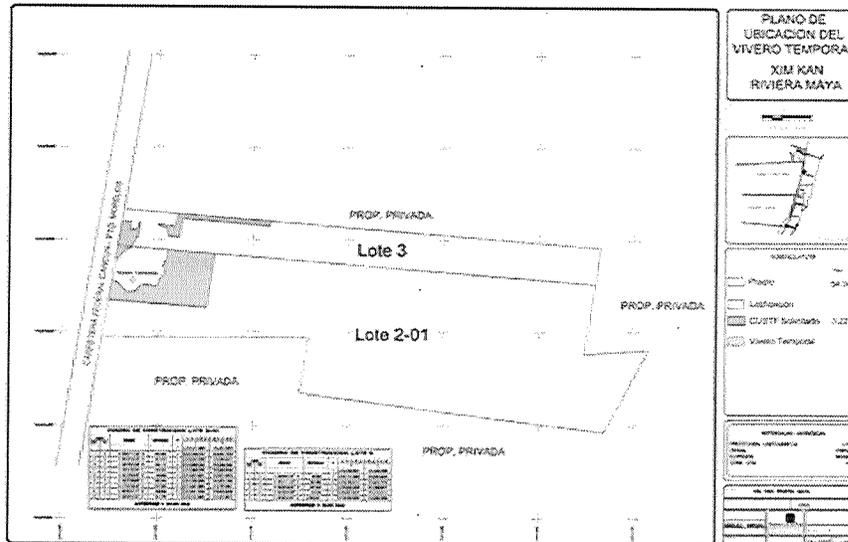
Plano de ubicación del vivero temporal para acopio de plantas
